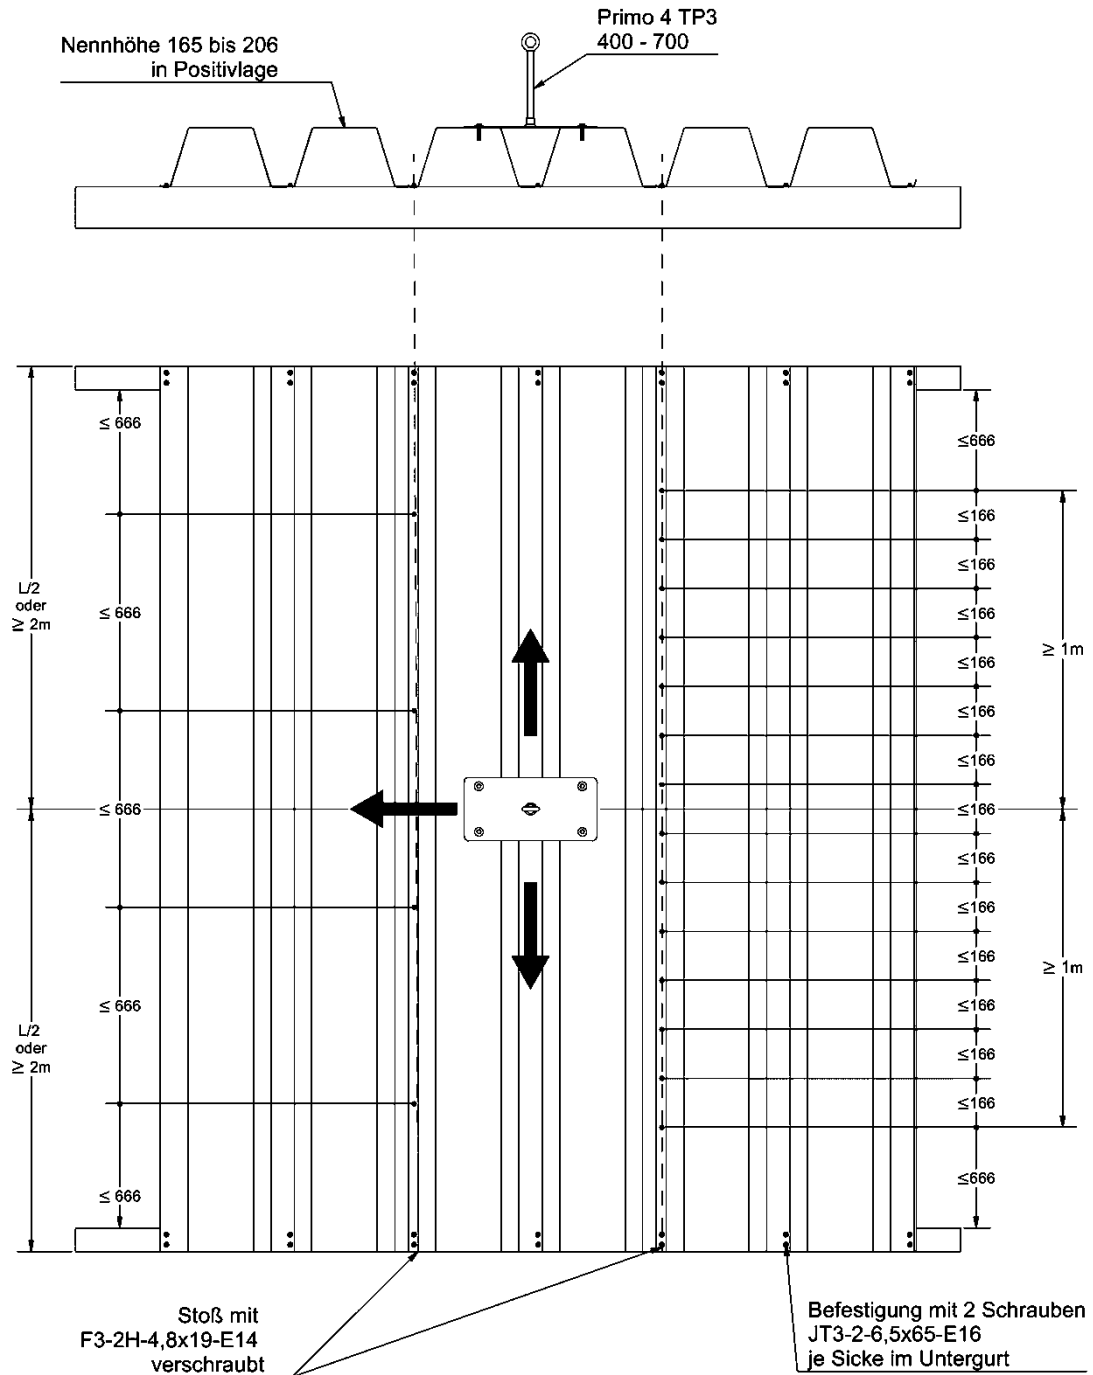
Primo 4 TP3, Variante D: Positivlage, Befestigung im anliegenden Gurt (siehe Zeichnung mit 1 oder 2 Schrauben), Profilhöhen 165 bis 206 mm, Blechdicke 0,75mm
